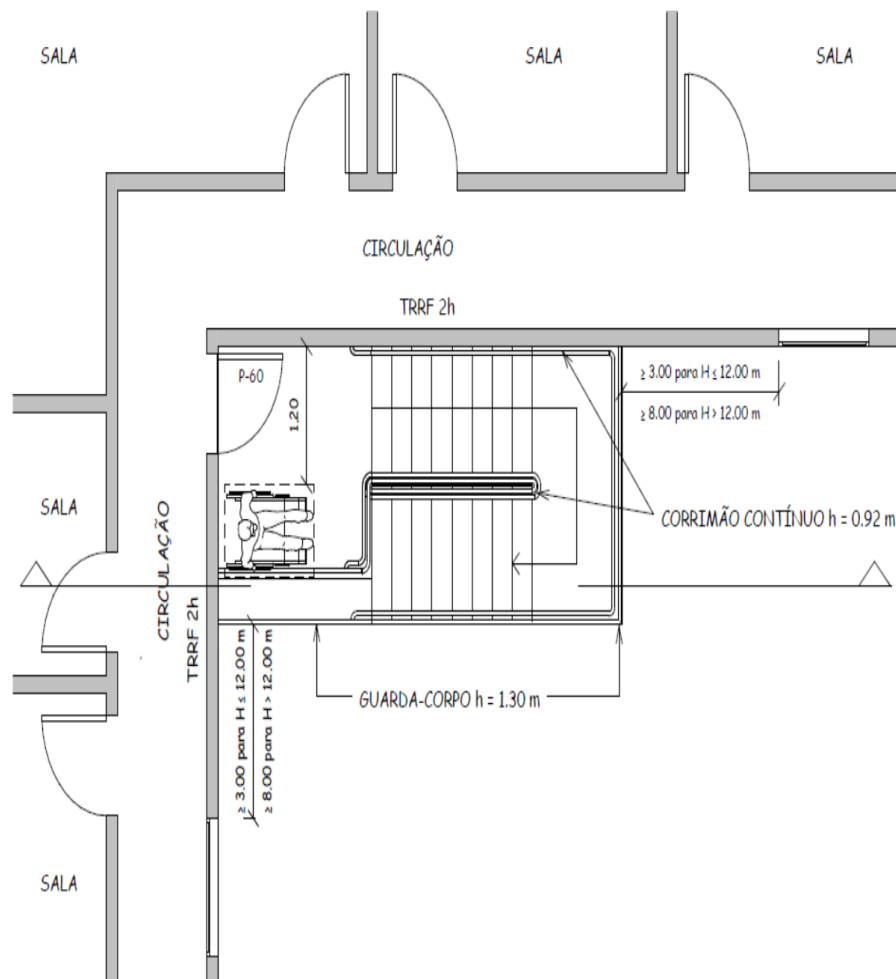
C - Escada aberta externa - último pavimento (planta baixa).
